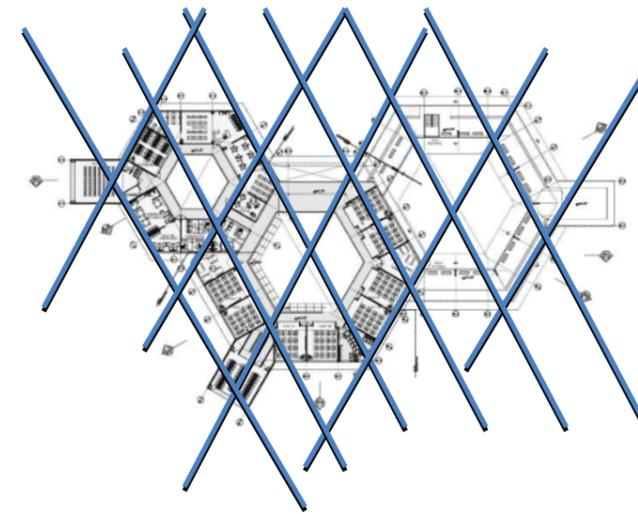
Geometría del proyecto. Fuente: Fundación Pies Descalzos, 2004
